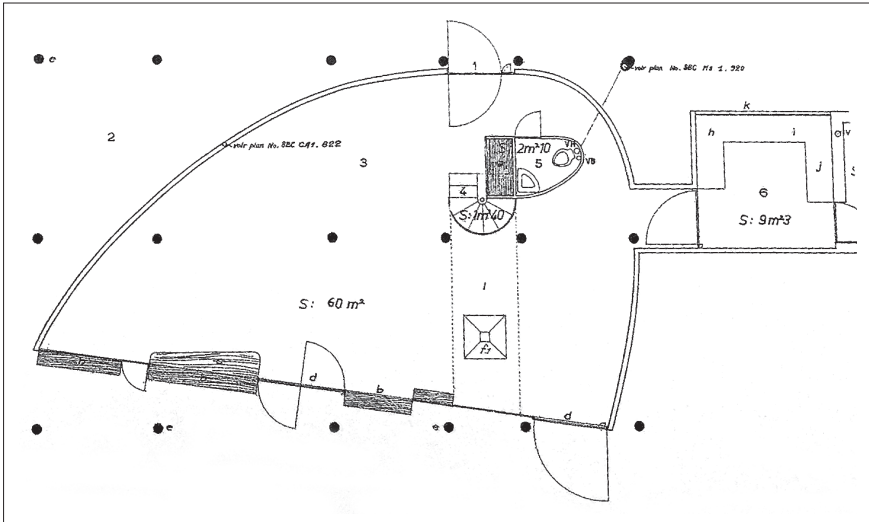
Saint-Brevin-les-Pins, villa Chupin, plan du rez-de-chaussée (© Fondation Marta Pan)
